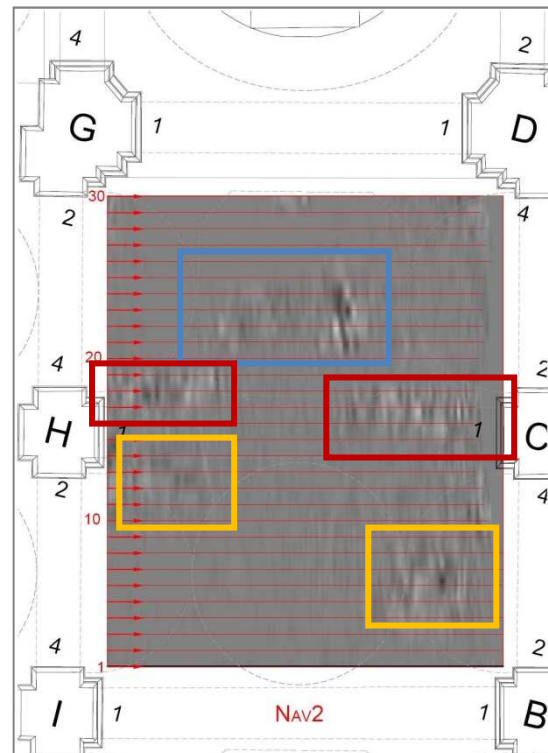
Sezione radar ricavata dai profili trasversali a 58 cm.
